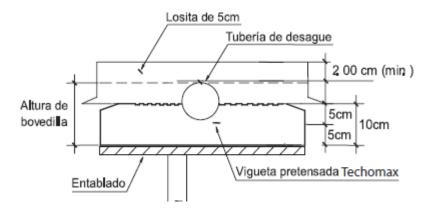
Detalle de las instalaciones sanitarias en el sistema tipo Firth parte I.
